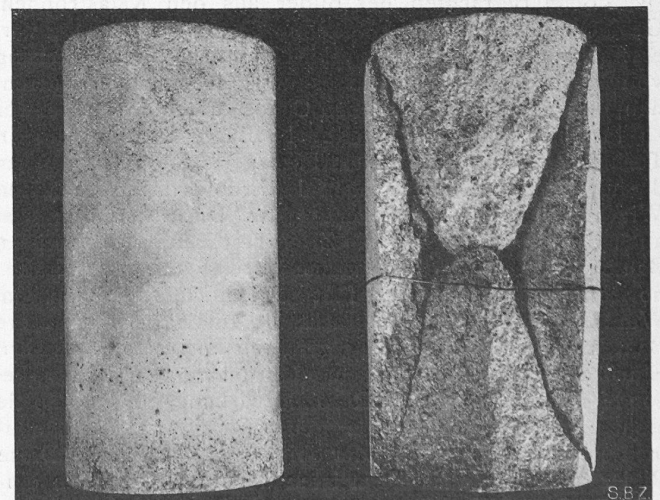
Typisches Bruchbild eines vertikal zerdrückten Betonkörpers.
